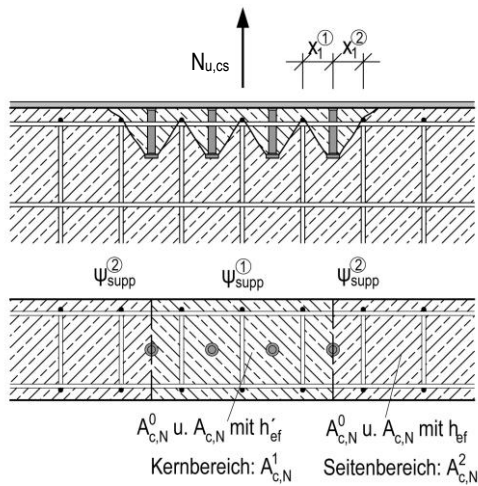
Betonausbruch zwischen der Bewehrung der randnahen, liegenden Kopfbolzen
